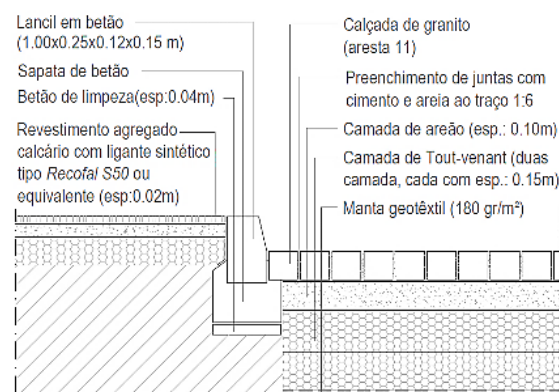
Corte do Pavimento em cubo de granito [13]
